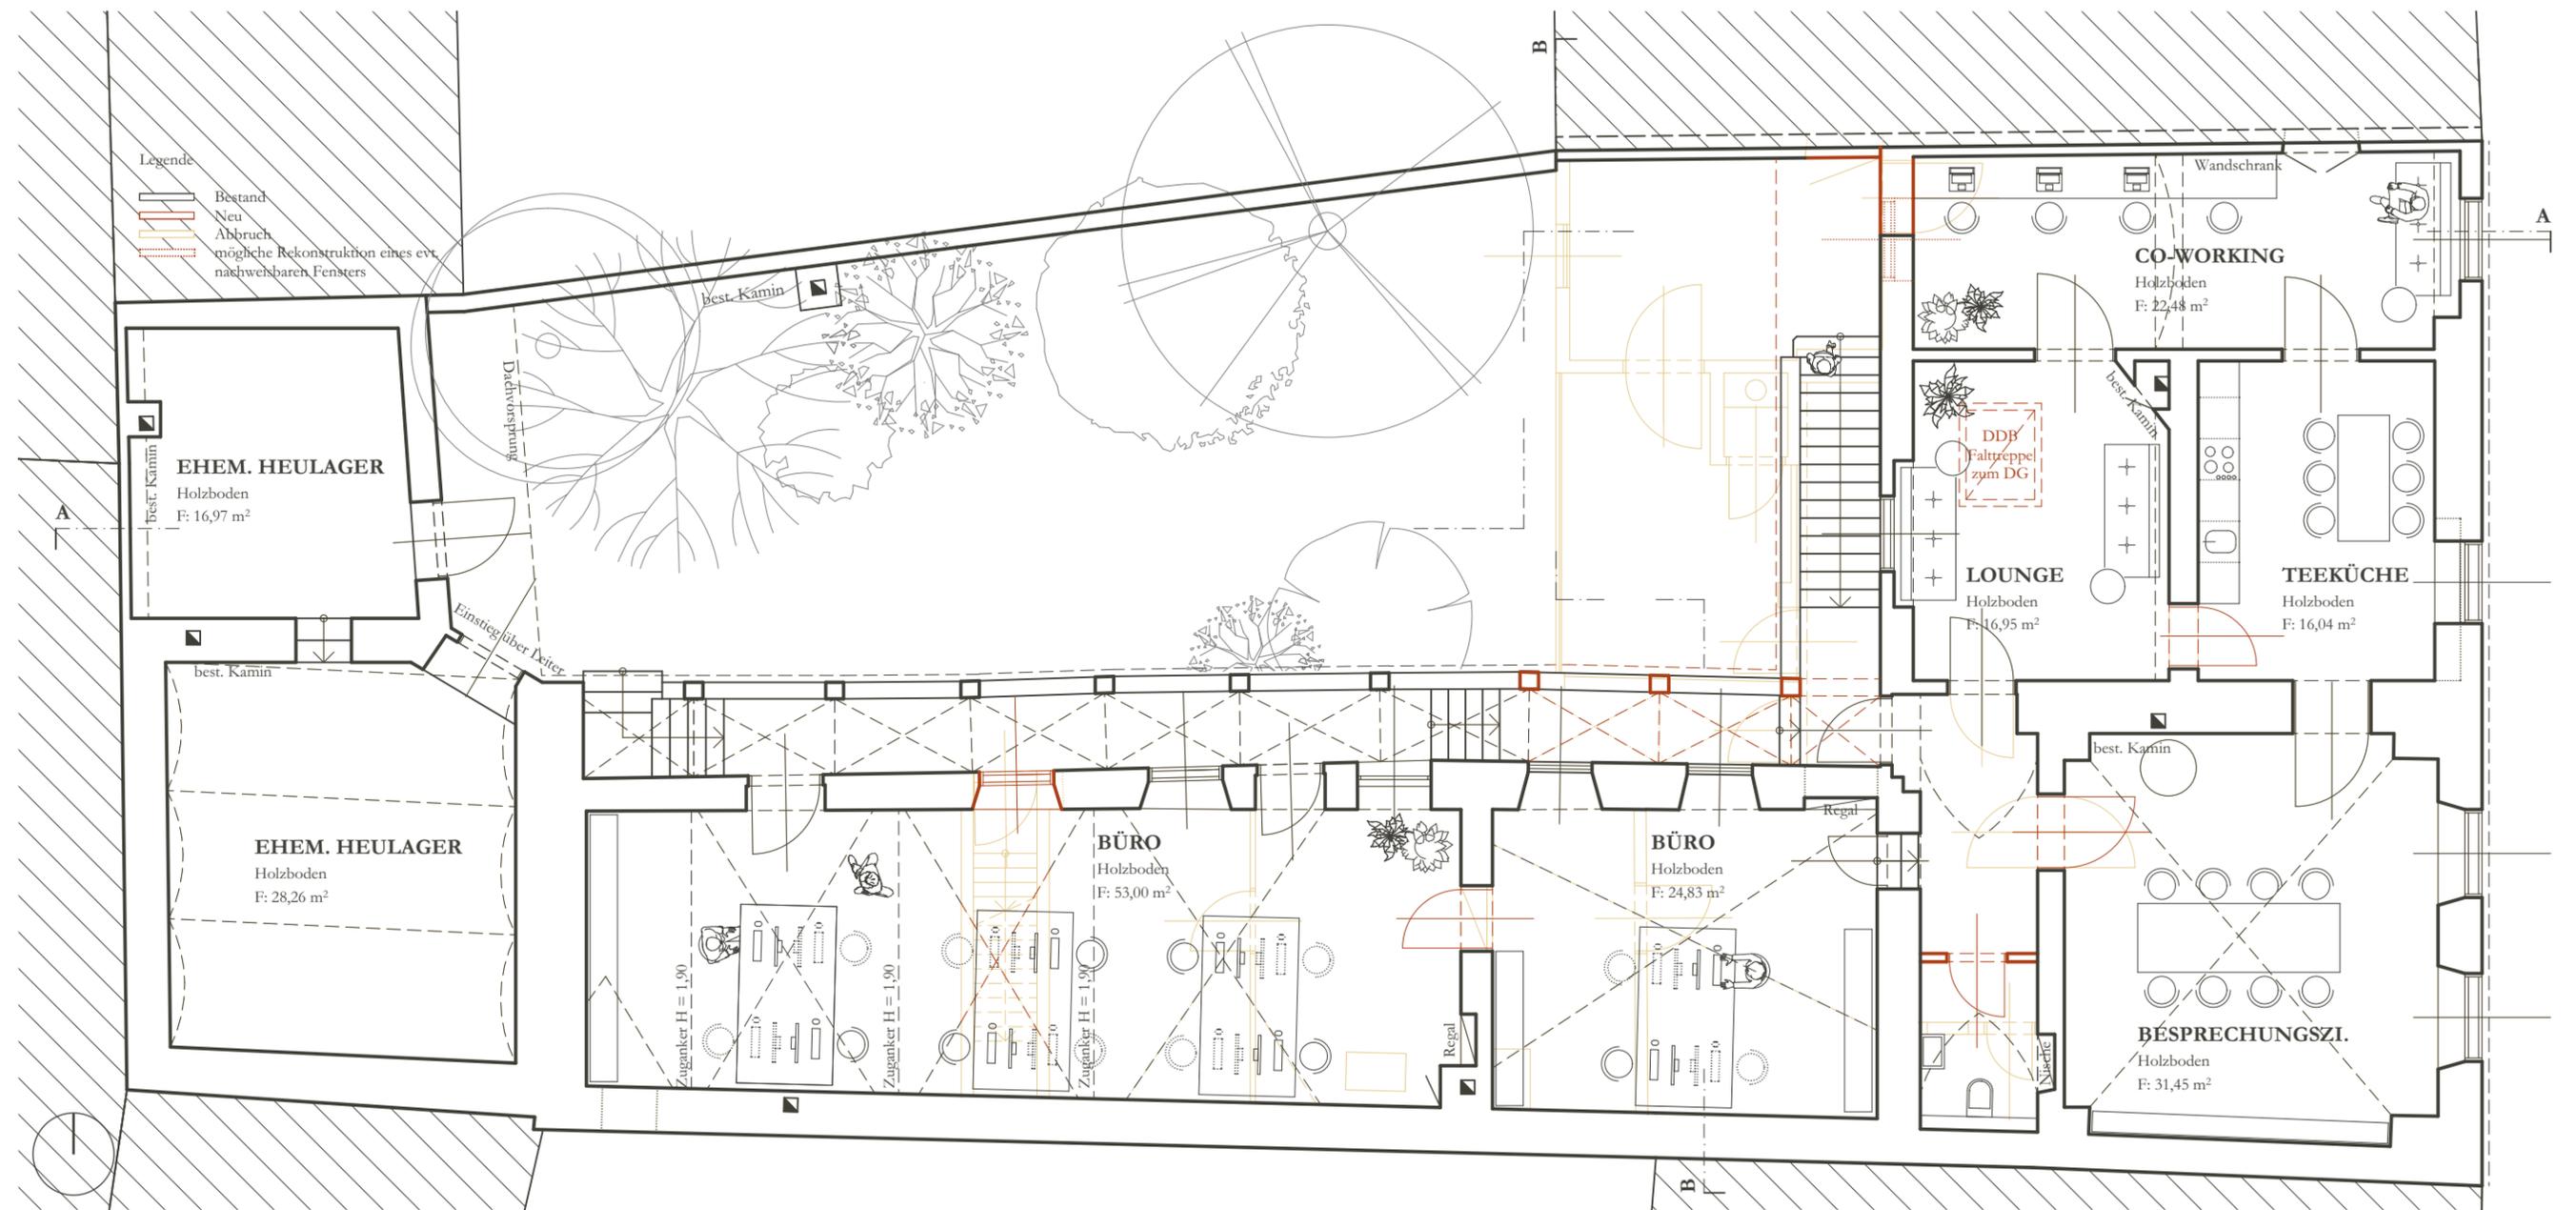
Entwurststudie Obergeschoß, M 1:100
